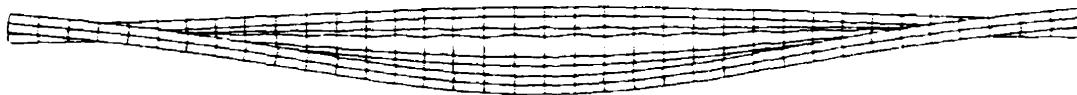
Poutre avec raidisseurs transversaux simples et raidisseur longitudinal, vue en plan
